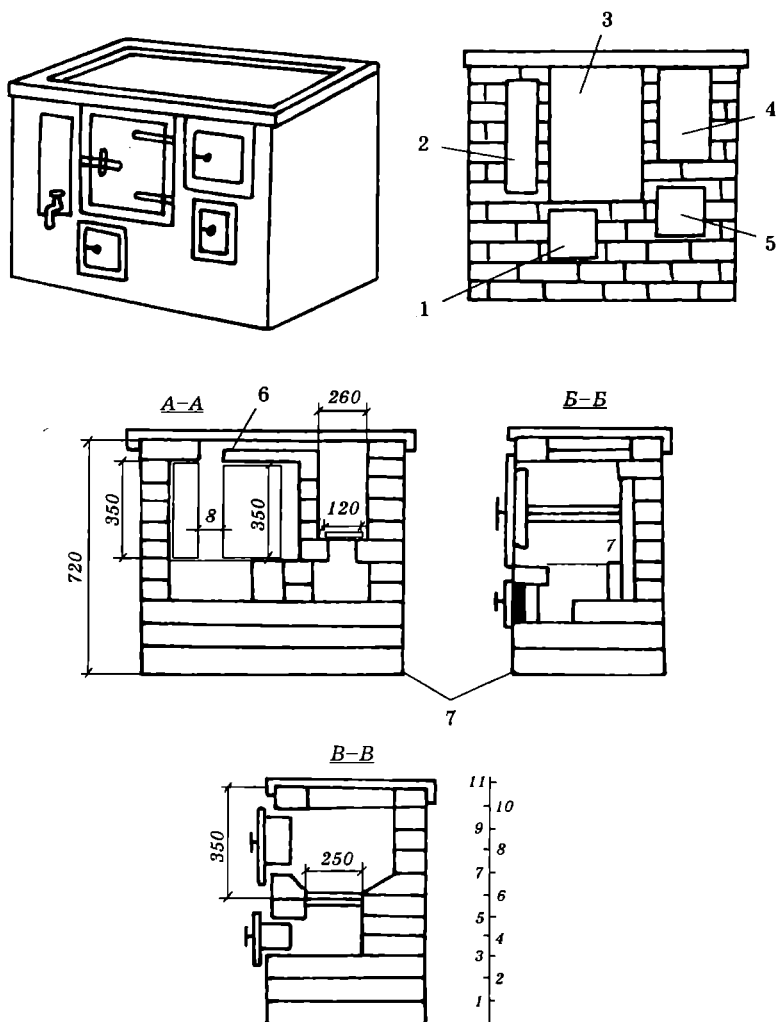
Кухонный очаг с духовкой и водогрейной коробкой:
